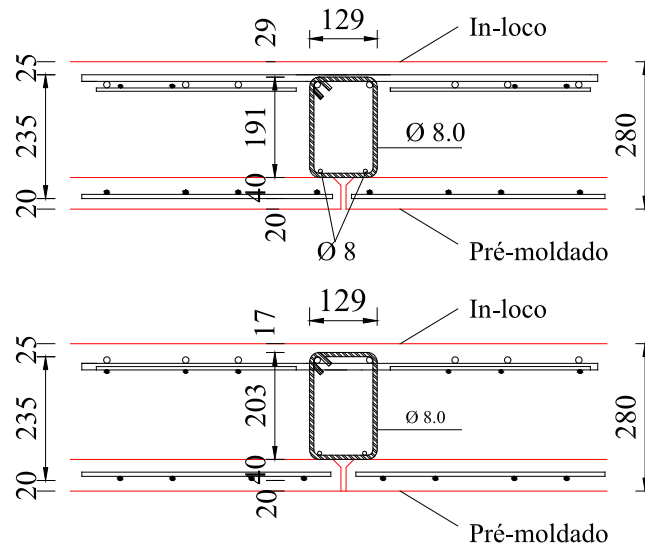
Detalhe da armadura de cisalhamento na laje SS2
